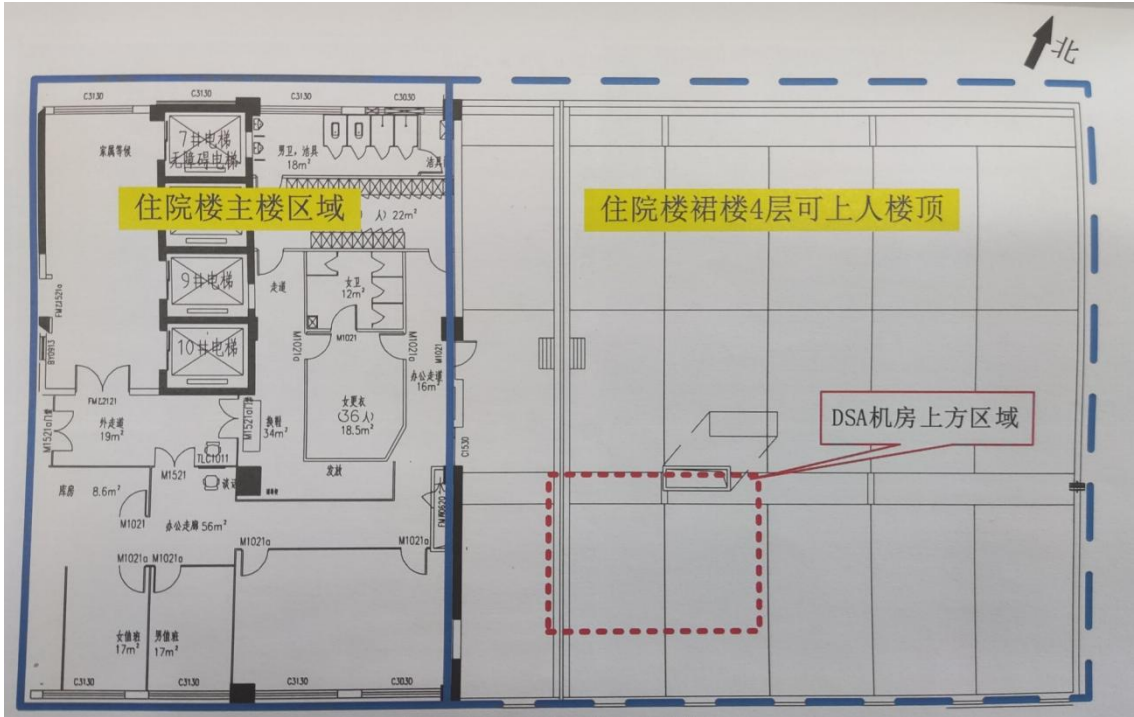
医疗综合楼（住院楼）顶楼局部平面布置图
